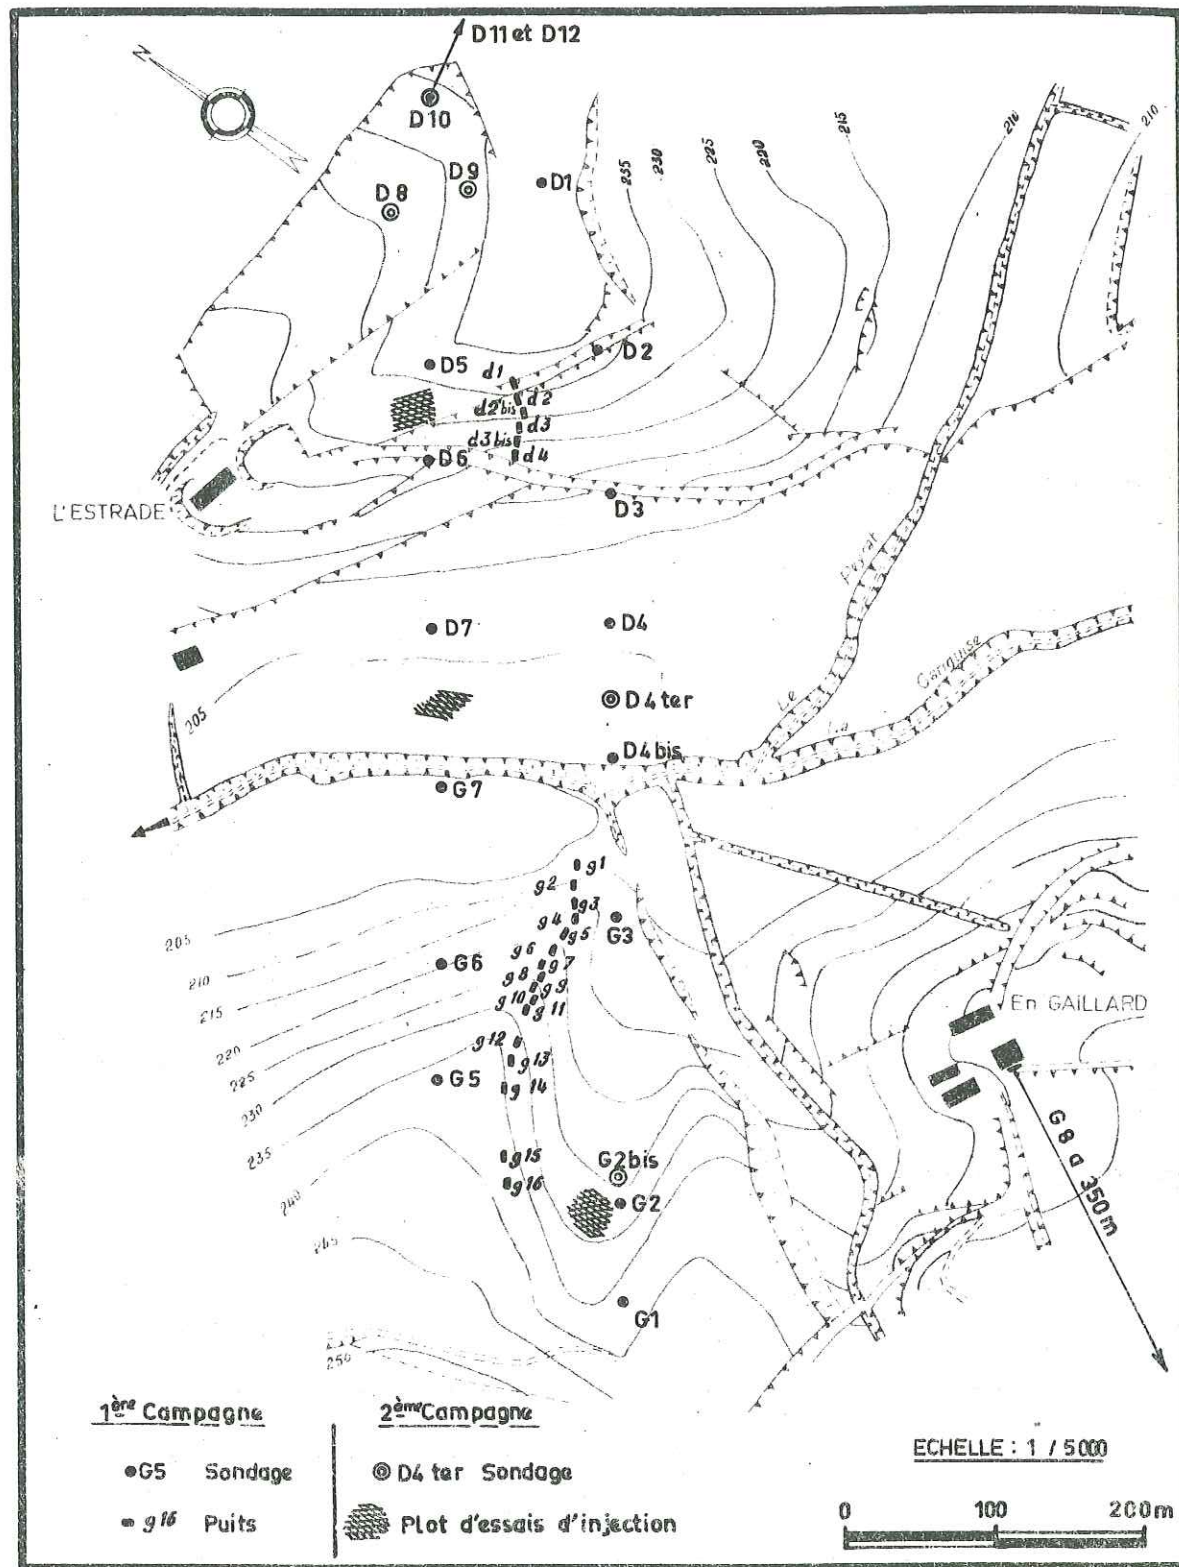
IMPLANTATION DES TRAVAUX DE RECONNAISSANCE COMPLEMENTAIRE AU BARRAGE DE L'ESTRADE
